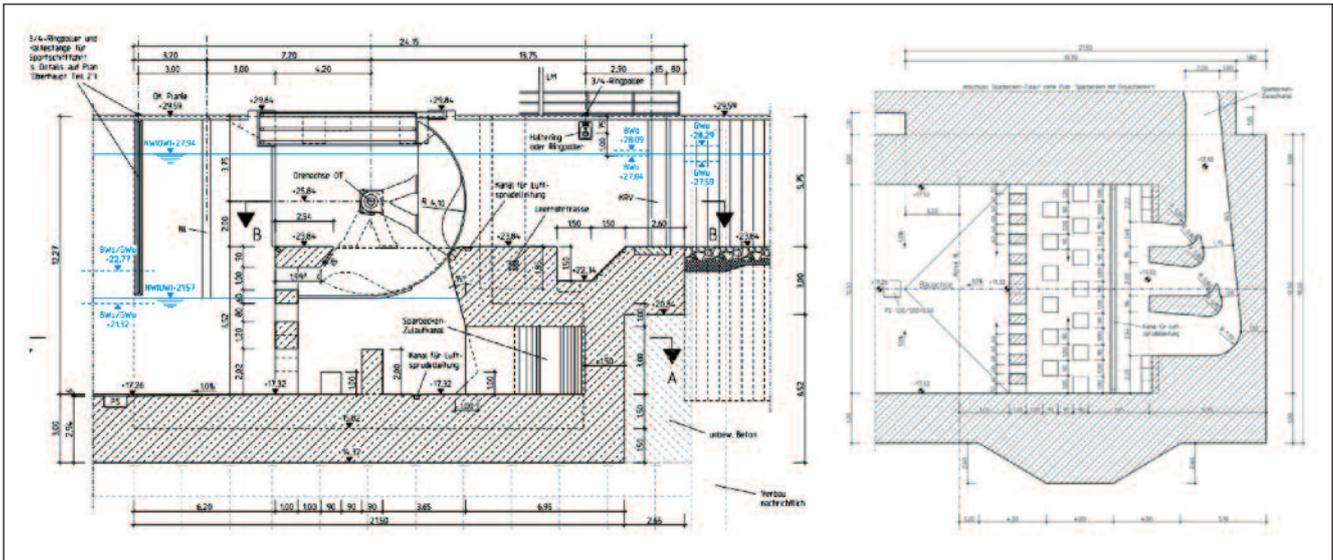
Längsschnitt und Grundriss Oberhaupt der neuen Schleuse Gleesen
